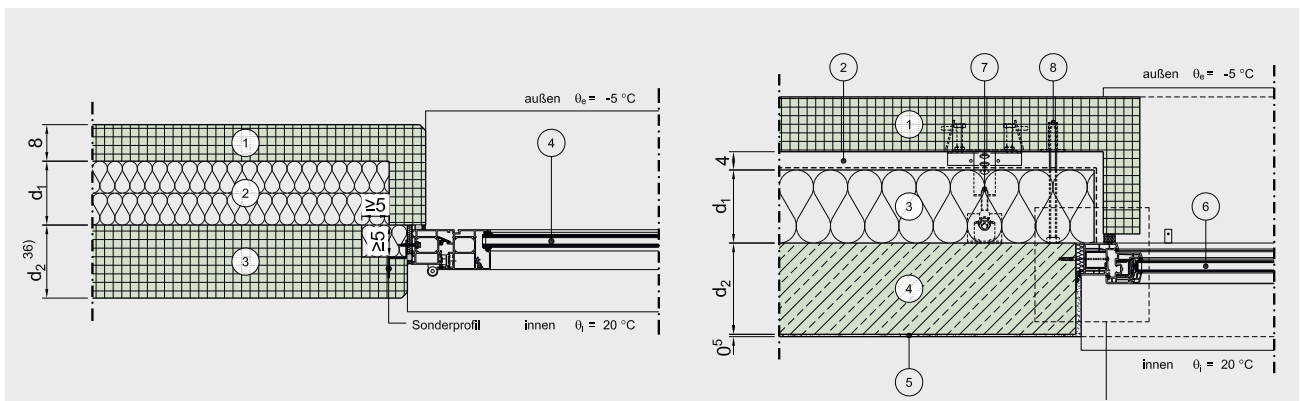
Beispiele aus dem Planungsatlas für den Hochbau für Sandwichfassaden (links) und vorgehängte Fassaden (rechts)
